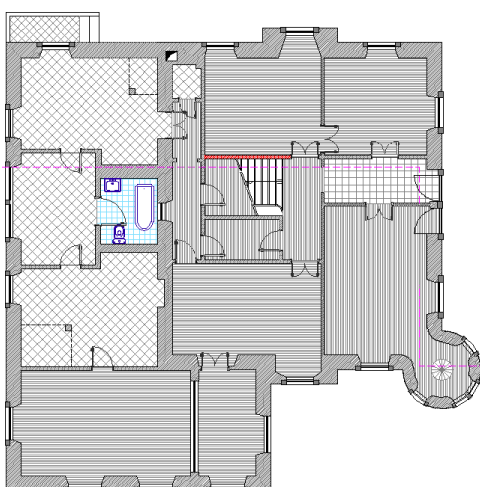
Localização em planta da fissuração e fendilhação nas paredes divisórias do rés-do-chão.
